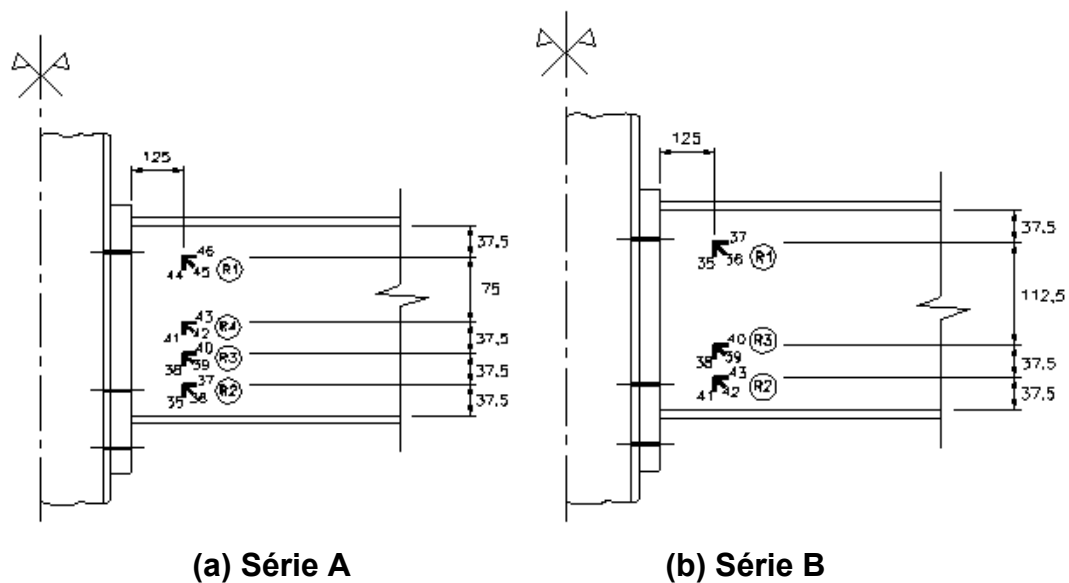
Rosetas na alma da viga (Grupo 1)
